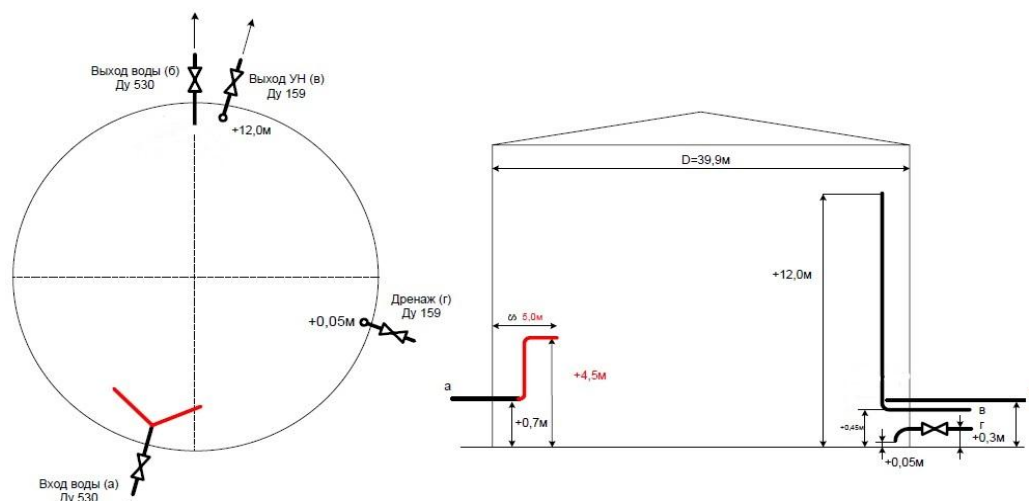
Начинка резервуара РВС-20000 УПСВ-Юг Ванкорского месторождения-предлагаемая конструкция №2.
